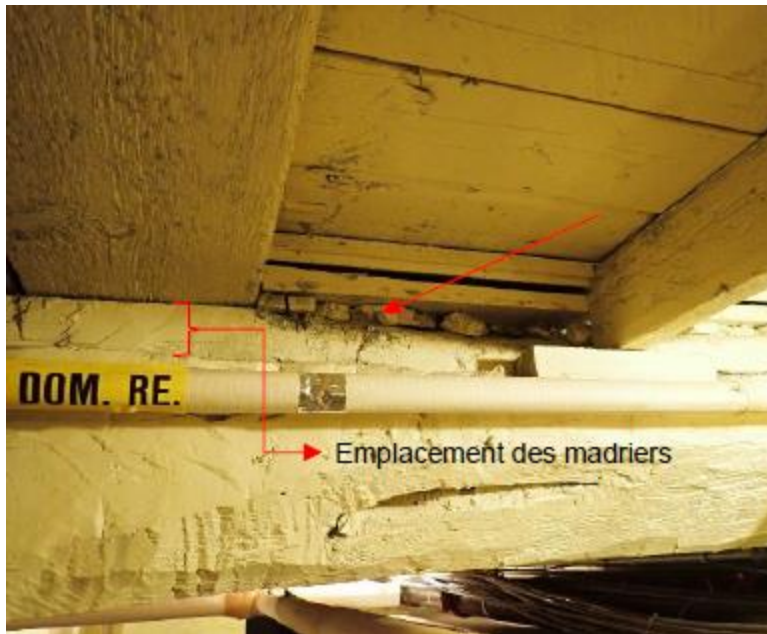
mortier prélevé du hourdage (n° 1.11) entre une poutre et le plancher
